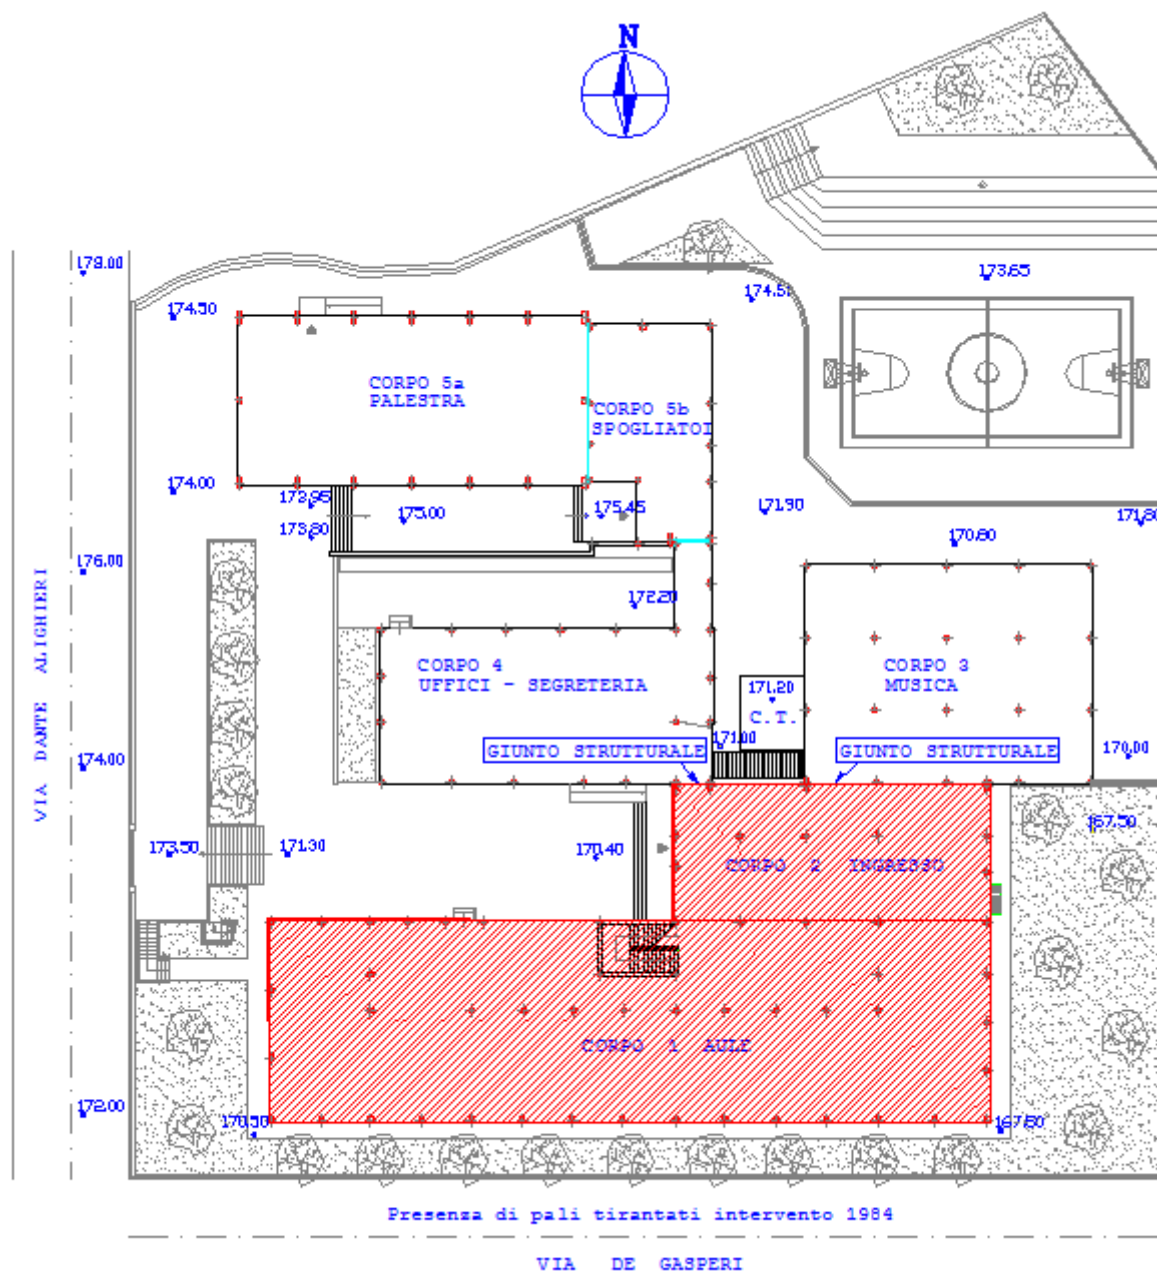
Configurazione planimetrica – visibili il corpo 1 (rettangolo più grande) e corpo 2
